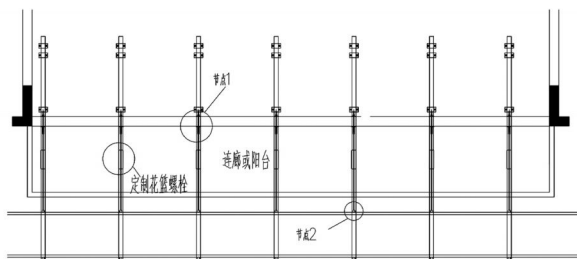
连廊或阳台部位悬挑脚手架工字钢及钢管布置平面图
